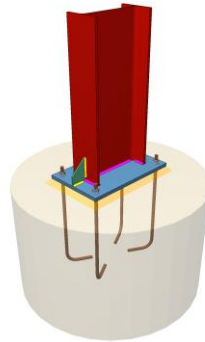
Placa de anclaje de los pilares del atillo
